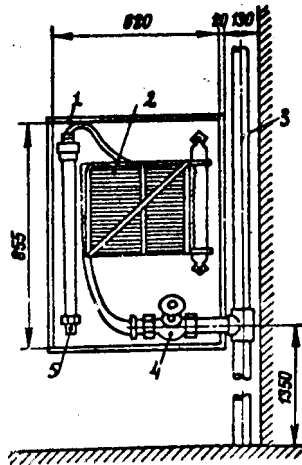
Схема размещения пожарного крана на внутреннем пожарном водопроводе:
